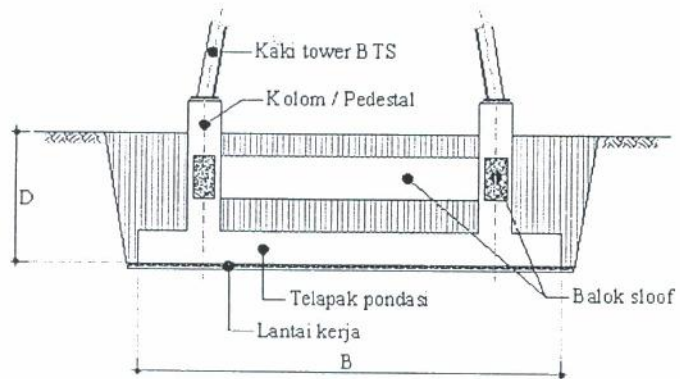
Pondasi setempat (Potongan pondasi)
